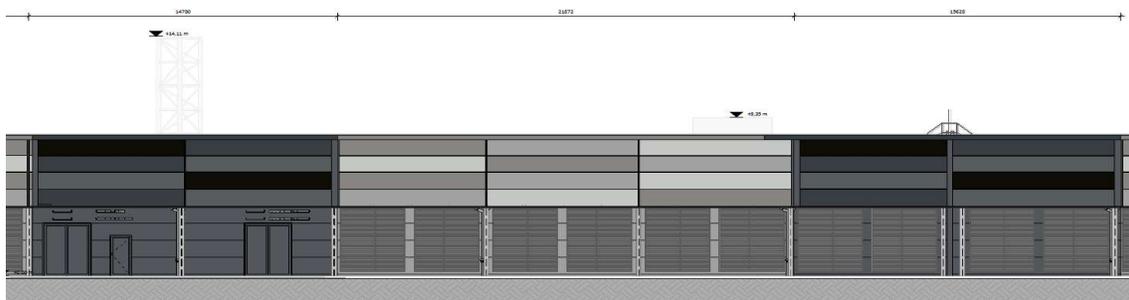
Concetto di suddivisione delle facciate – stralcio prospetto sud
